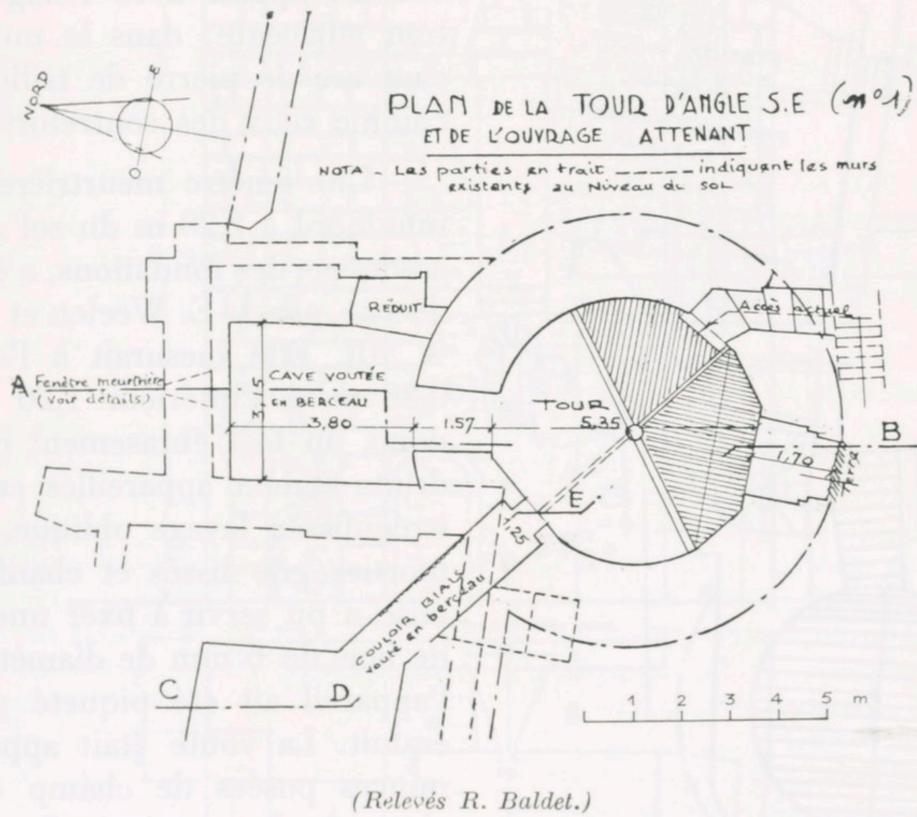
Châteauneuf, plan de la tour d'angle S.-E. (n° 1) et de l'ouvrage attenant; coupe suivant AB du plan.
